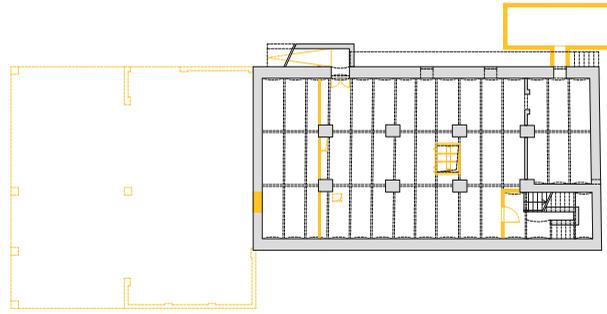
Grundriss Kellergeschoß, Abbruch / Neubau, M 1:500
